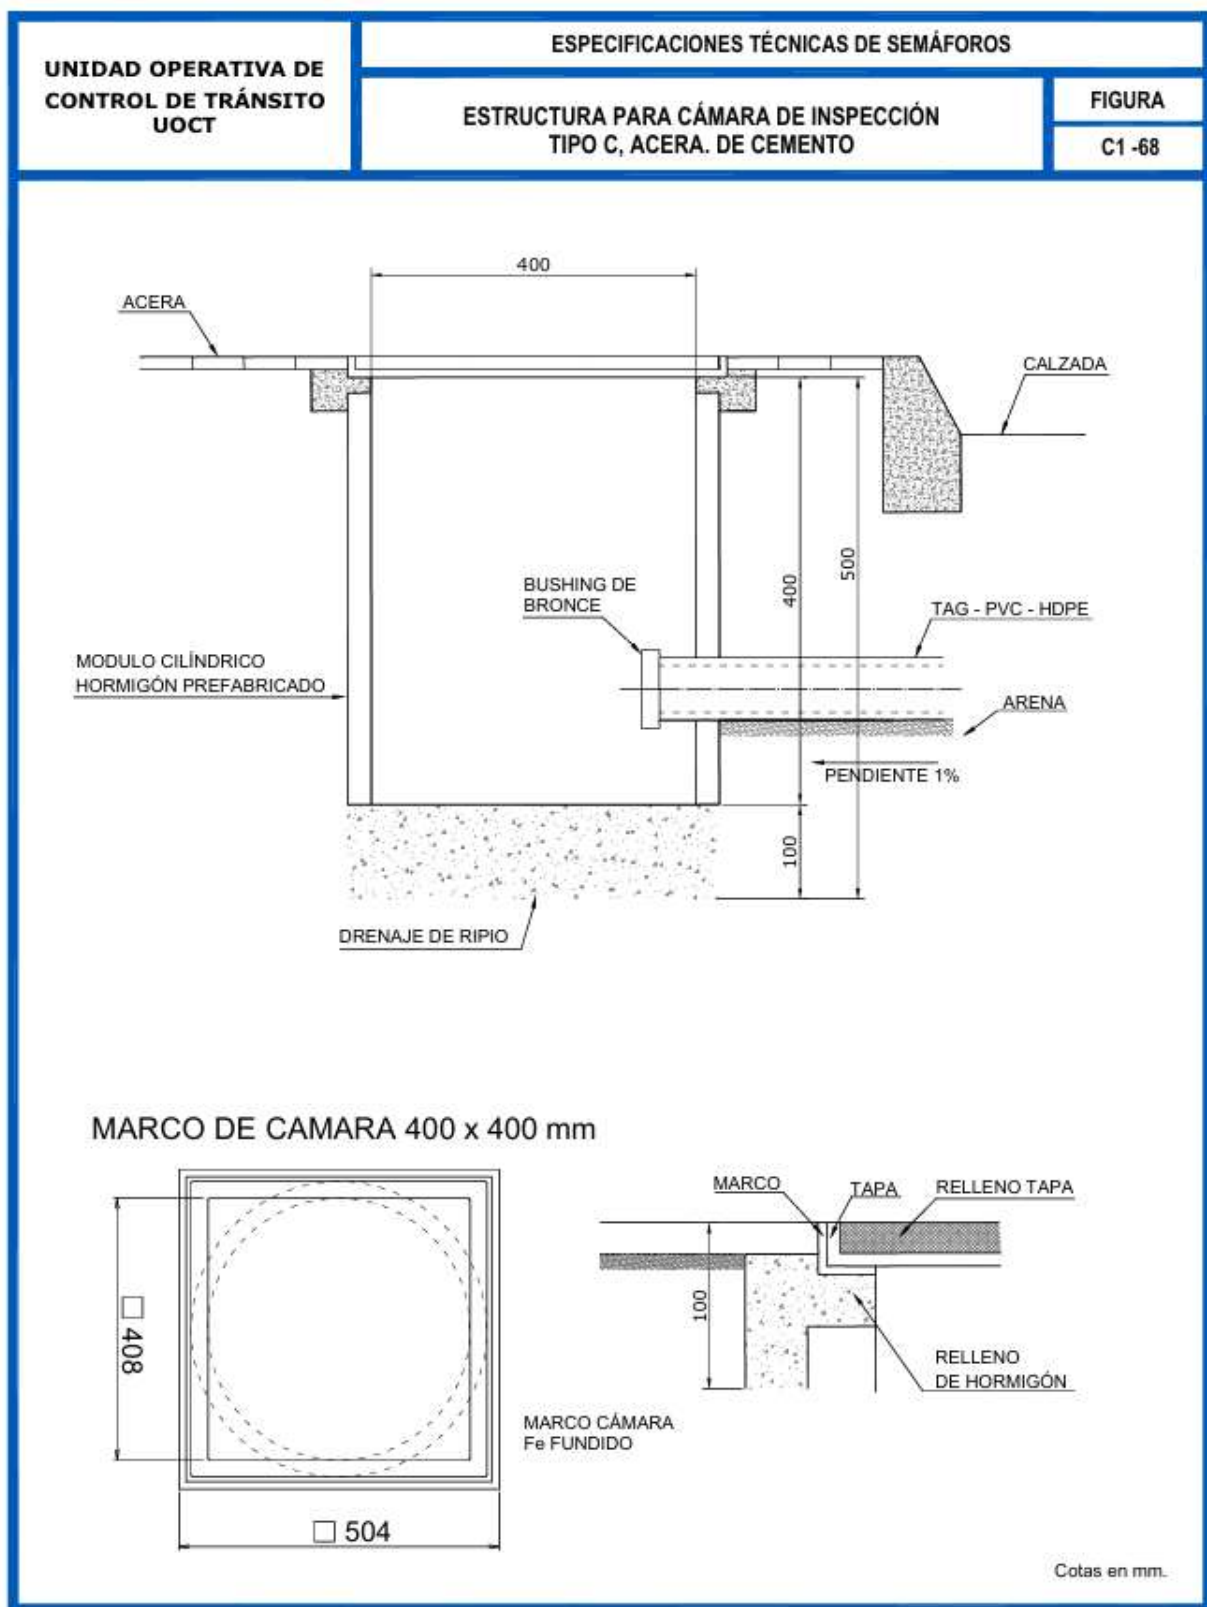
68 Estructura para Cámara de Inspección Tipo C, Acera de Cemento
